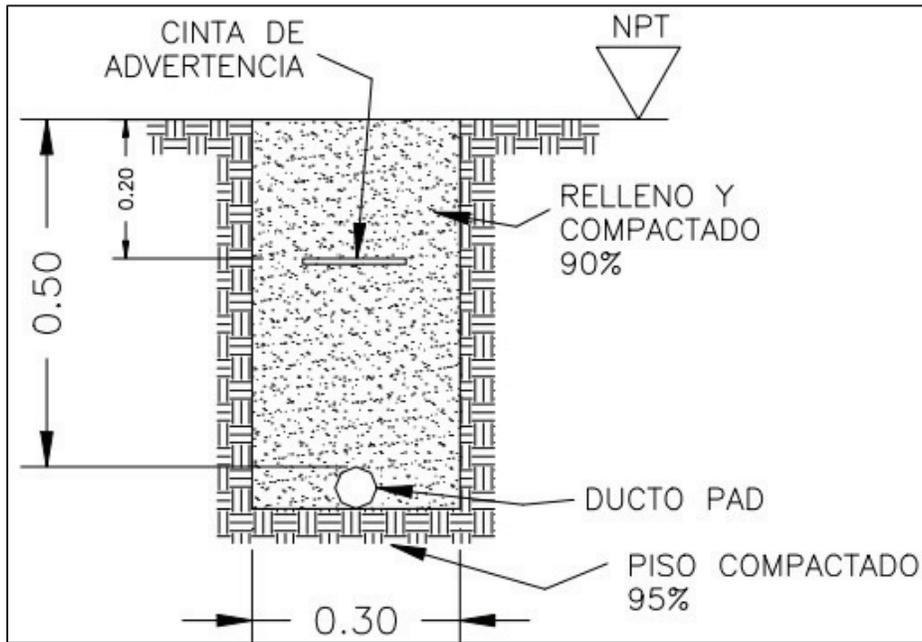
Detalle Ceba en Arroyo con Ducto de PAD.
